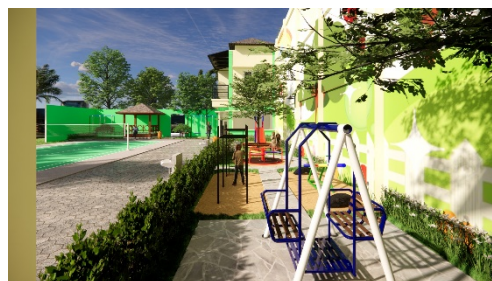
Tampak Depan Tiga Dimensi Ruang Bermain
